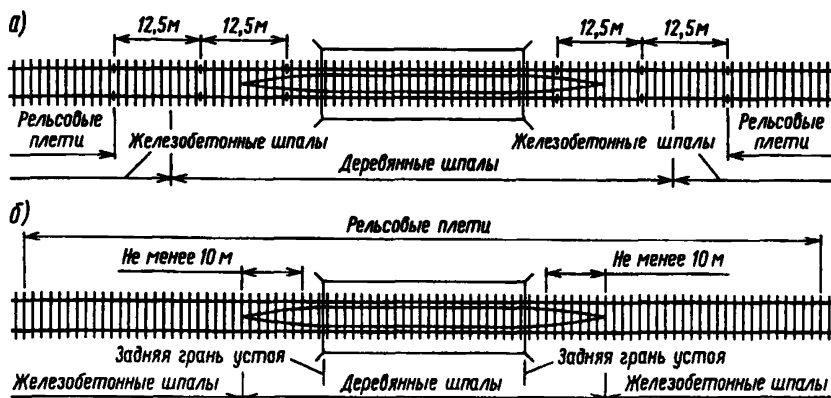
Схемы расположения железобетонных и деревянных шпал при примыкании рельсовых плит к мостам (а) и при перекрытии мостов рельсовыми плитами (б)
